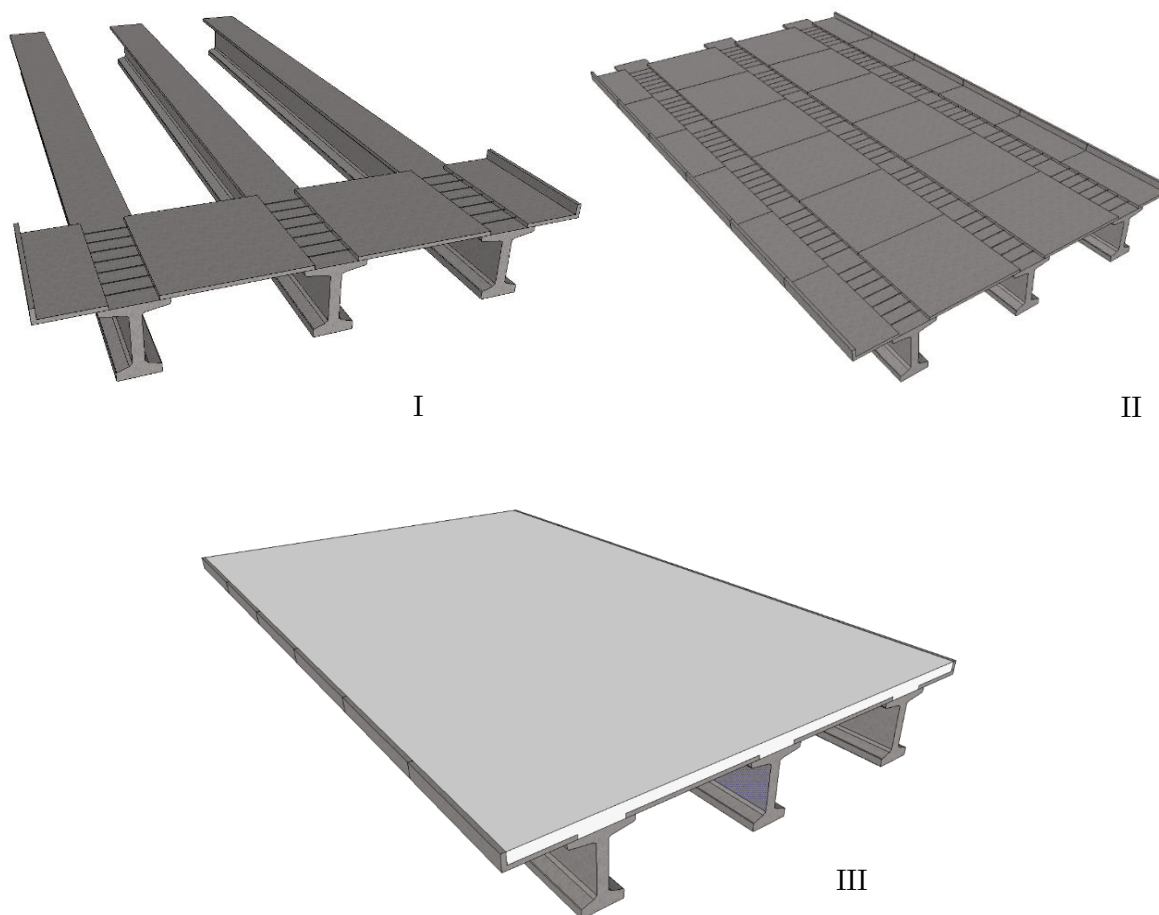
Fases construtivas da laje: I e II - Colocação das pré-lajes; III - Betonagem "in situ" da laje
